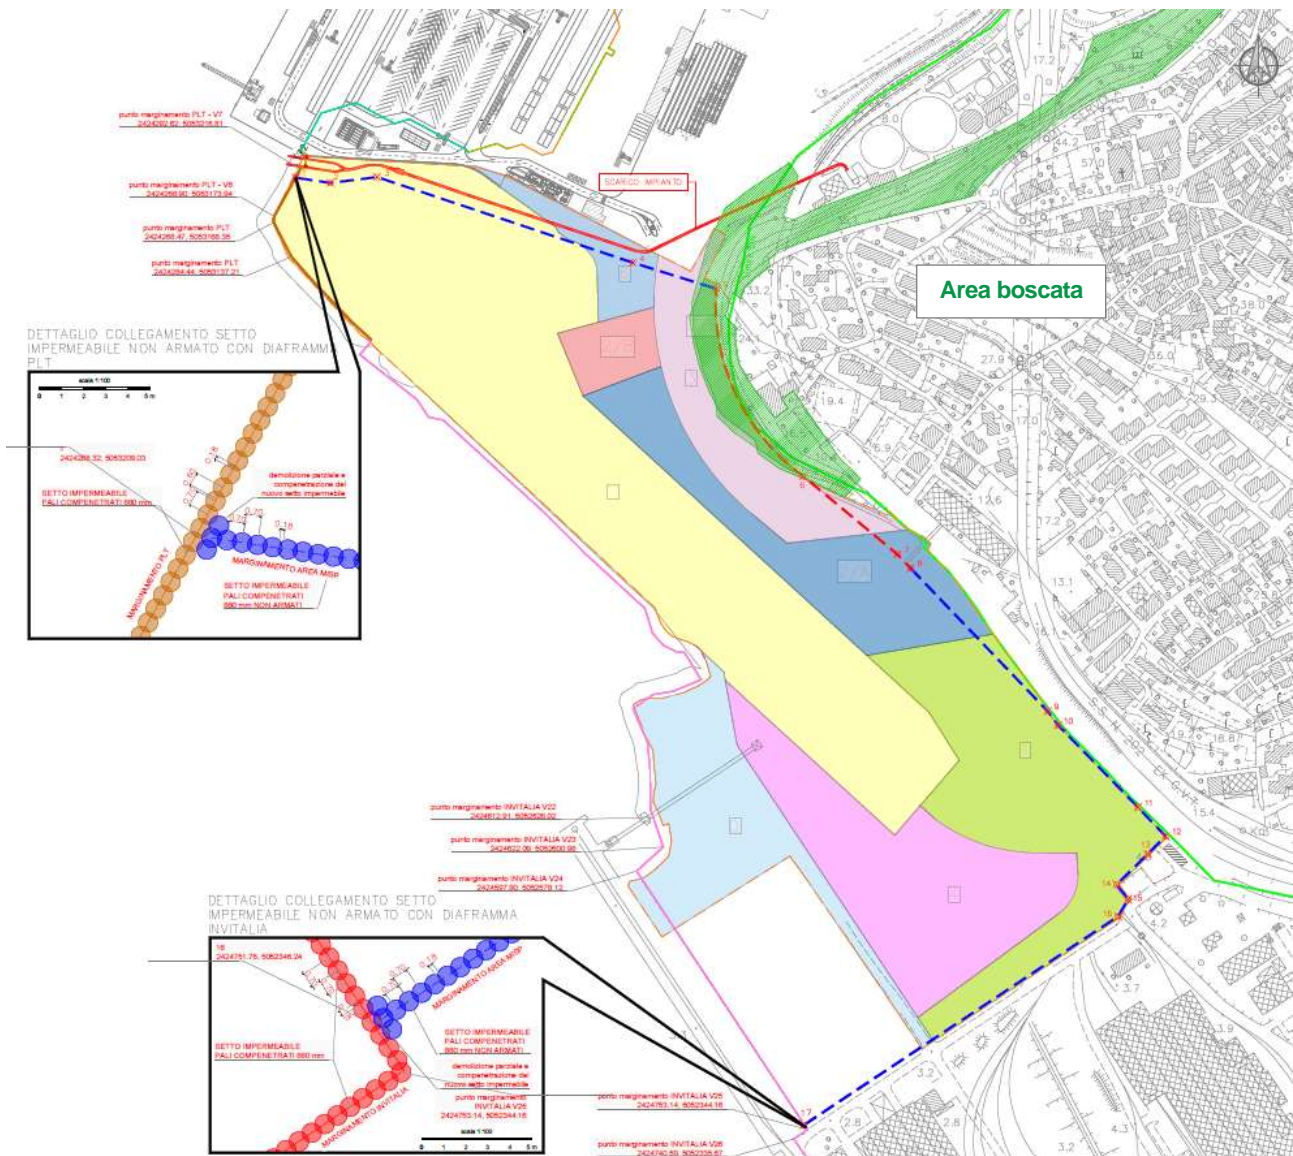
Estratto planimetria setto impermeabile con sovrapposizione area boscata
